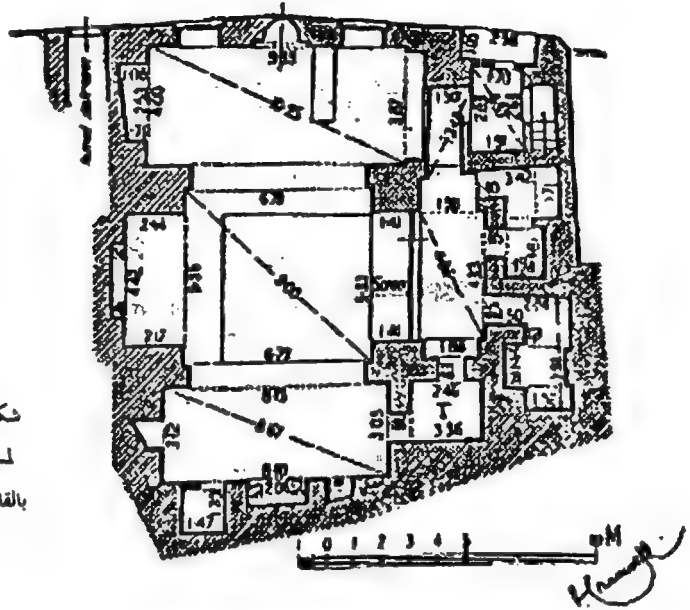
مسقط الأفقي لجامع قبة الماسحافي
